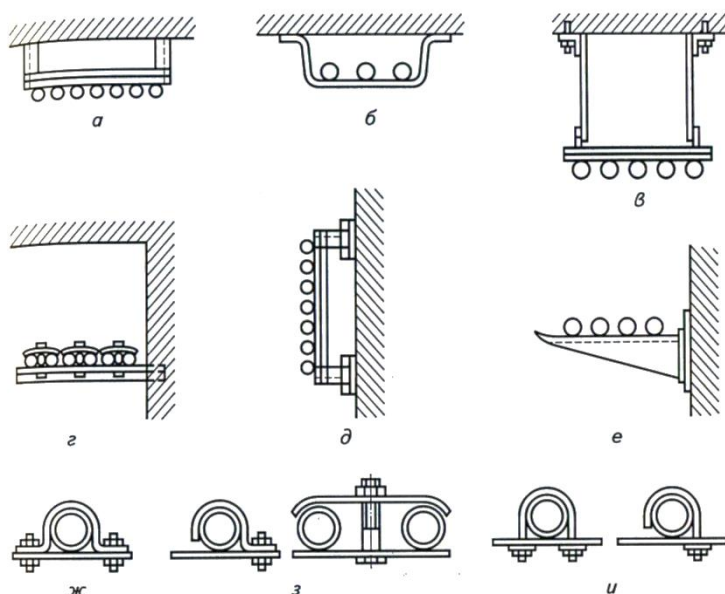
Способы крепления труб к опорным конструкциям: а, б, в - к потолочным опорным конструкциям из уголка, перфорированной полосы и на подвесках; г, д, е - к настенным опорным конструкциям и кронштейнам; ж, з, и - к хомутам, полухомутам, однолапковым скобам и накладкам.
